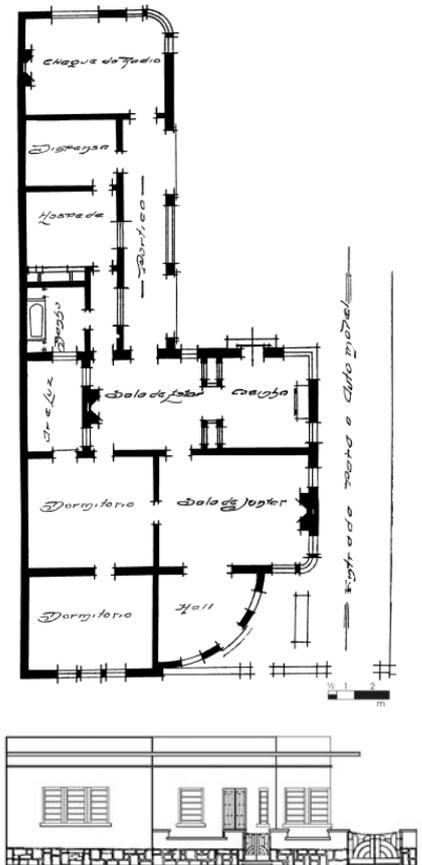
Casa Engenheiro Vasco (1938). Planta baixa e Fachada.
